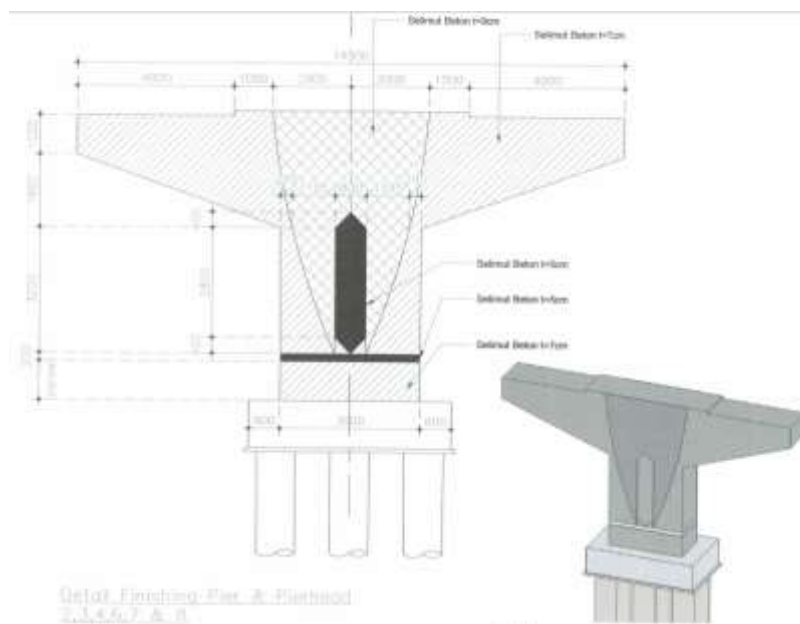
11. Gambar Rencana Pilar *Flyover* Ganefo Mranggen
